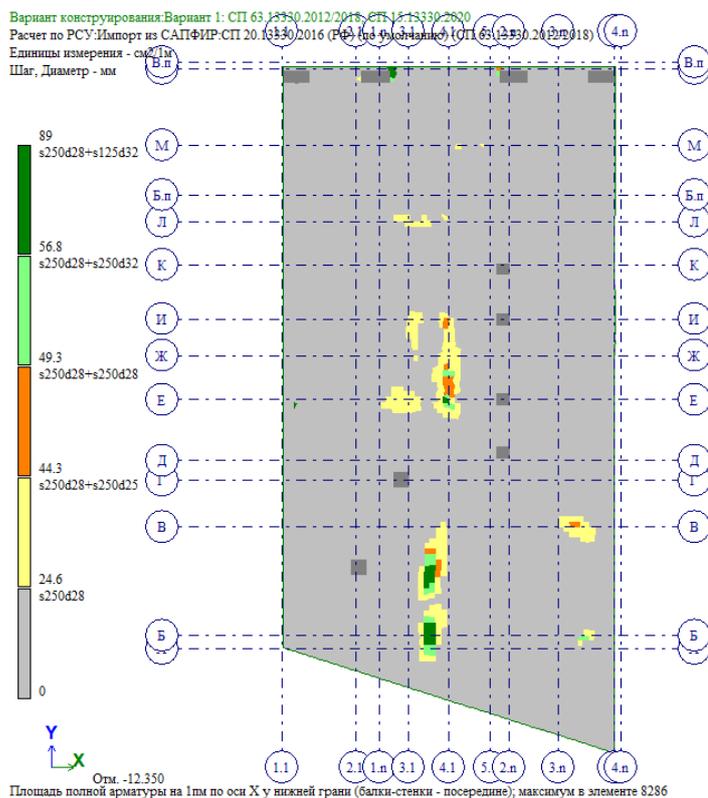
Армирование плиты по оси X у нижней грани (на 1 м.п.)
